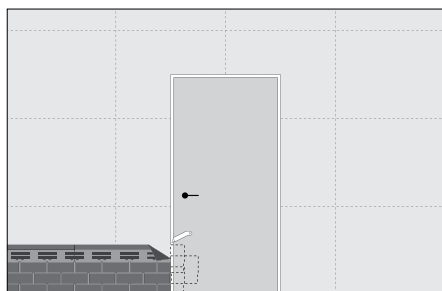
Монтаж фасадной плитки вокруг дверных проемов
